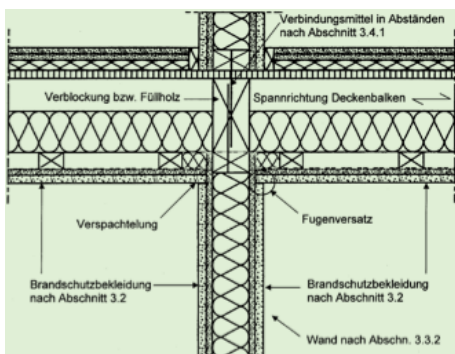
Anschluss Decke an tragende und raumabschließende Wand mit Brandschutzbekleidung nach der M-HFH-HolzR (z.B. Treppenraumwand, Außenwand - Spannrichtung der Deckenbalken senkrecht zur Wand)
